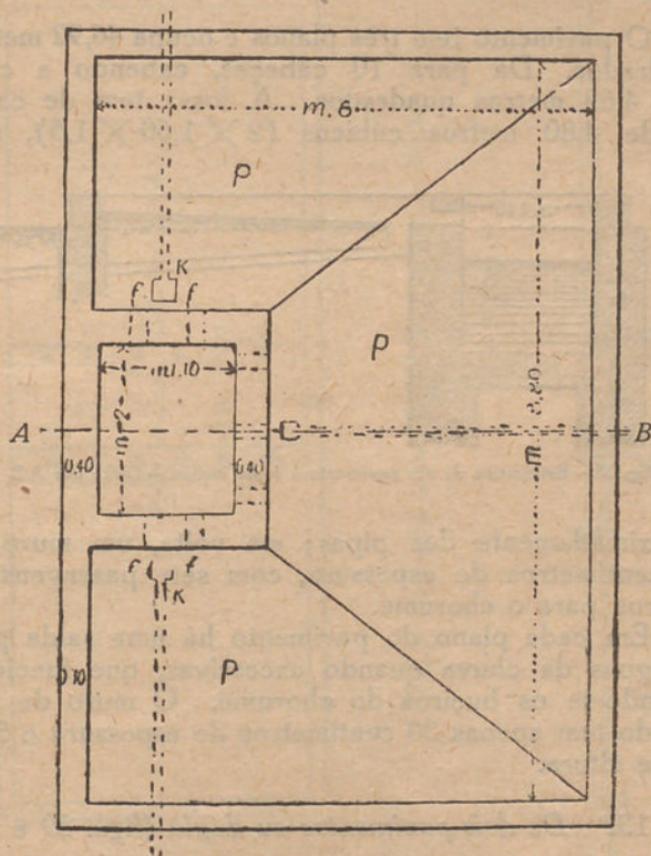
Estrumeira de um pavimento e fossa inclusa
